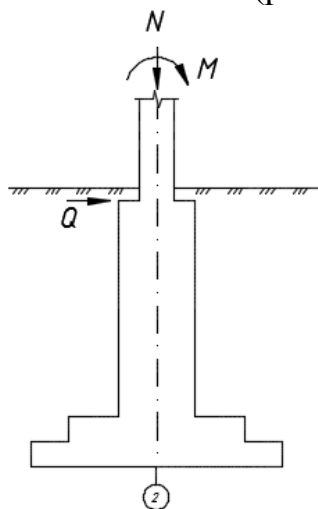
Схема нагрузок, действующих на фундамент
